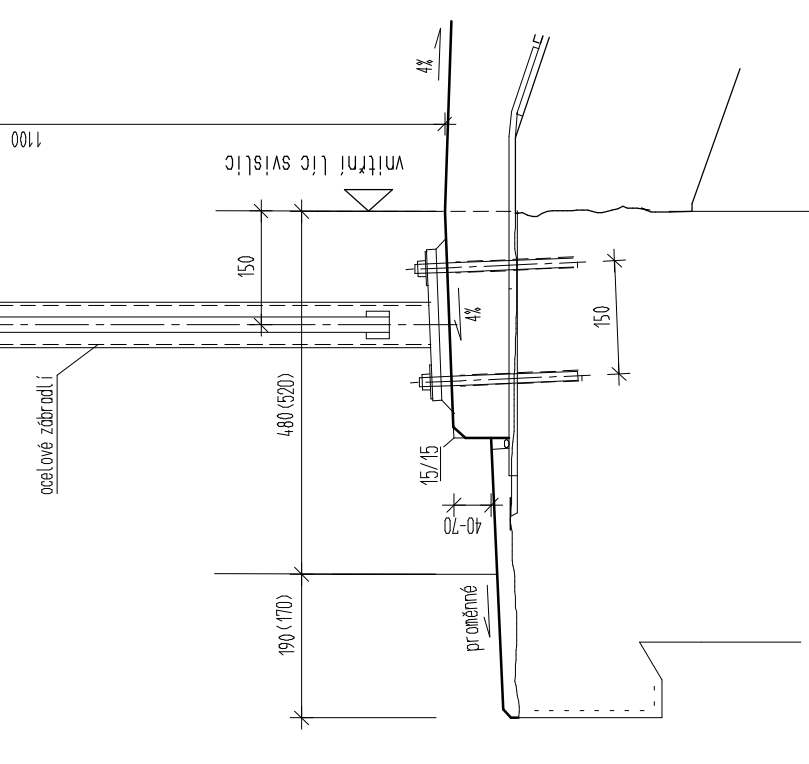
DETAIL PŘÍPOJENÍ VÝPLNĚ 1:5
